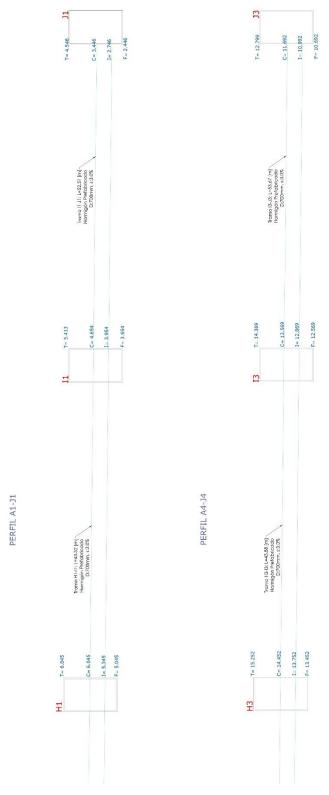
Perfiles Longitudinales. Parte 3. Fuente: Elaboración propia
